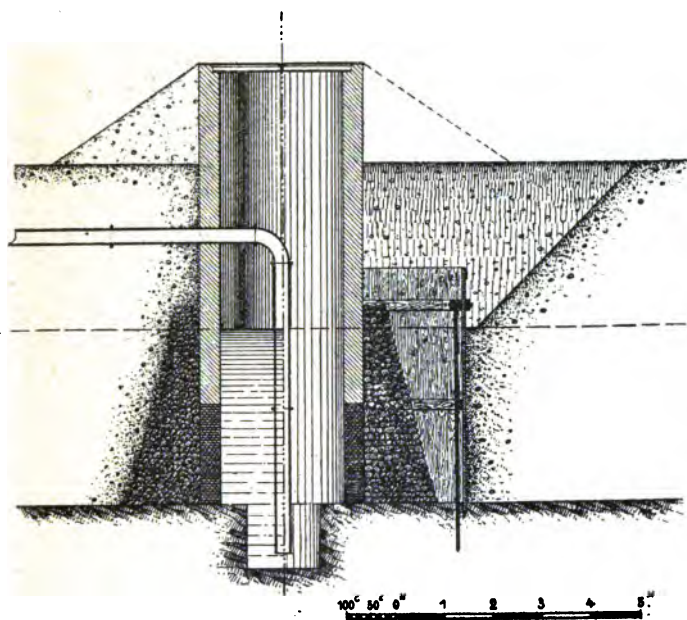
Coupe verticale d'un puits filtrant de Braqueville.
